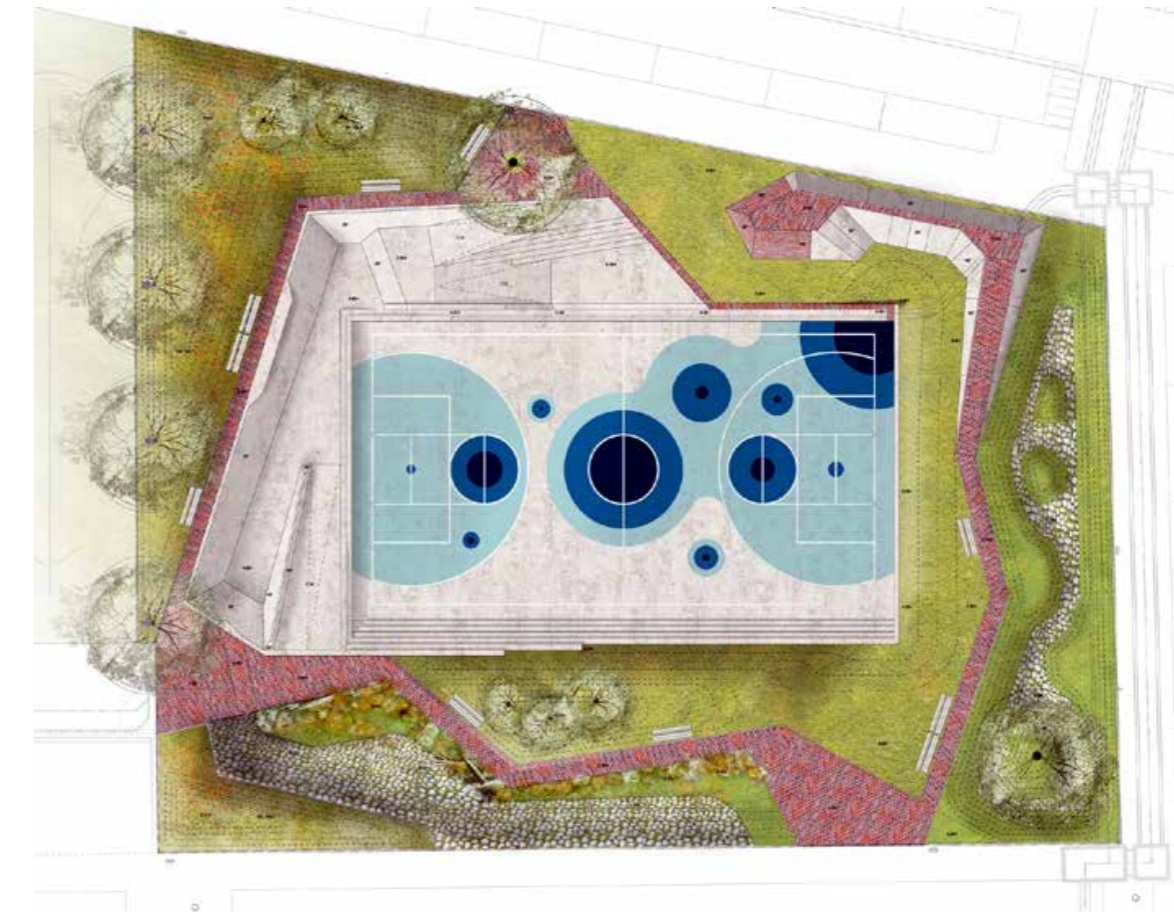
Grundriss des Waterpleins in Tiel
